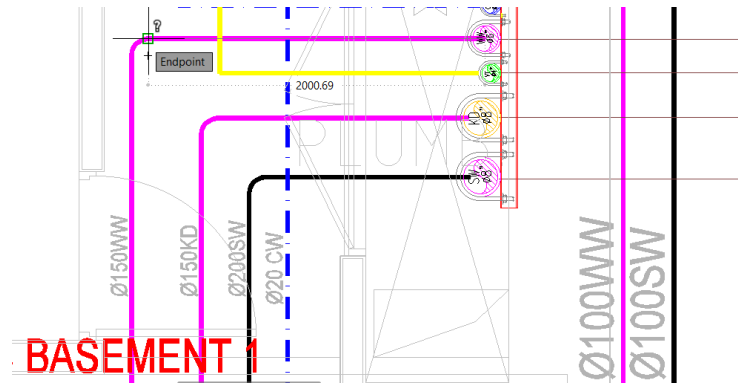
10 Denah Instalasi Air Kotor Lantai Basement 1
